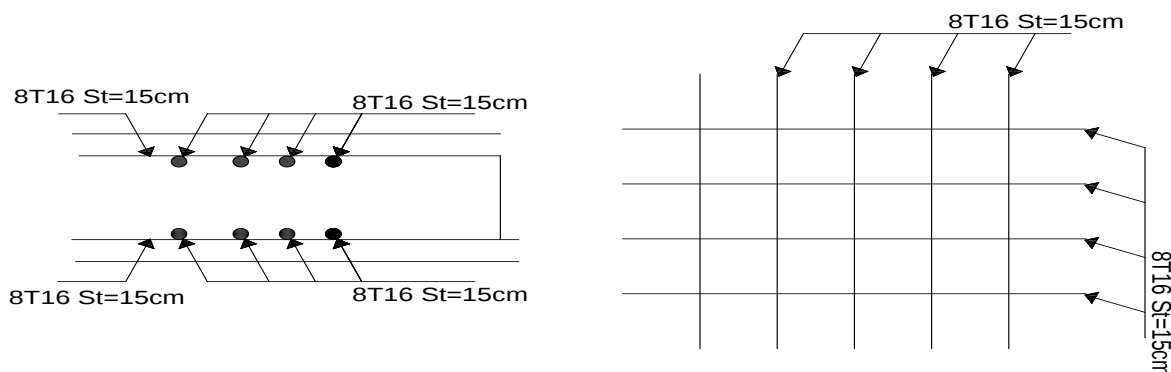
Le schéma du ferrailage de la dalle du radier.
